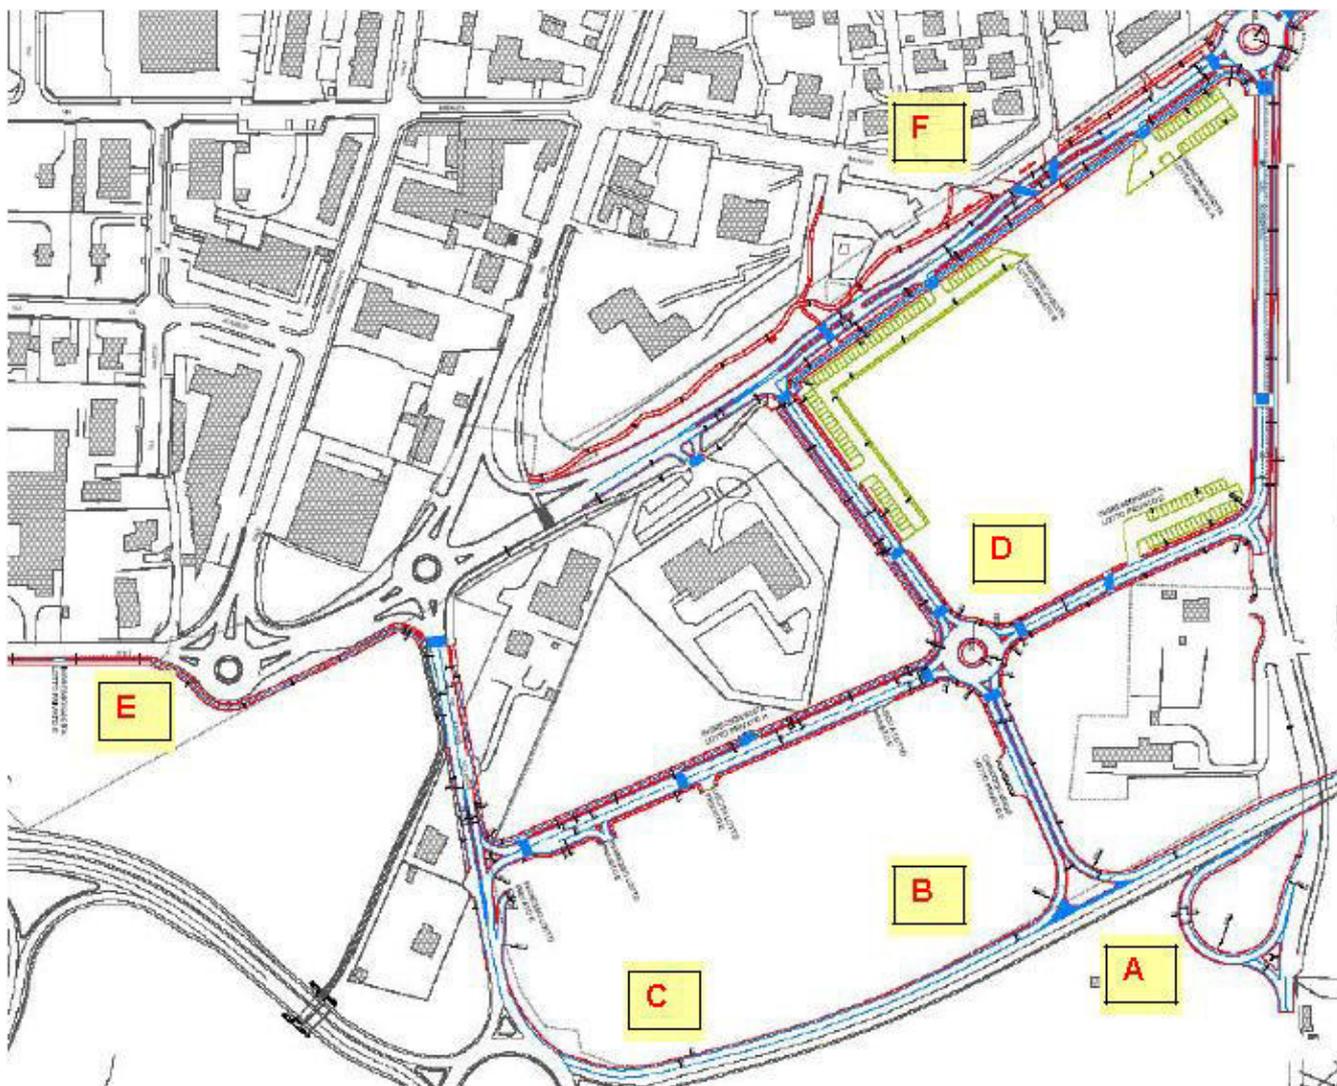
accessibilità veicolare proposta di PII – assetto iniziale
